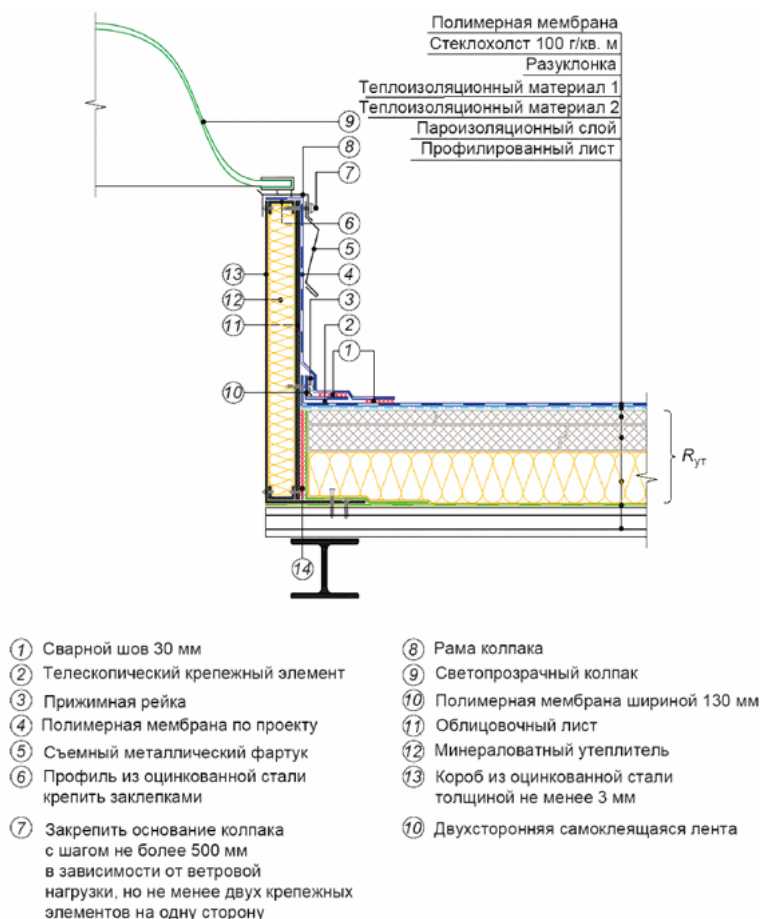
Схема установки фонаря для совмещенного кровельного покрытия с основанием из профилированного листа
